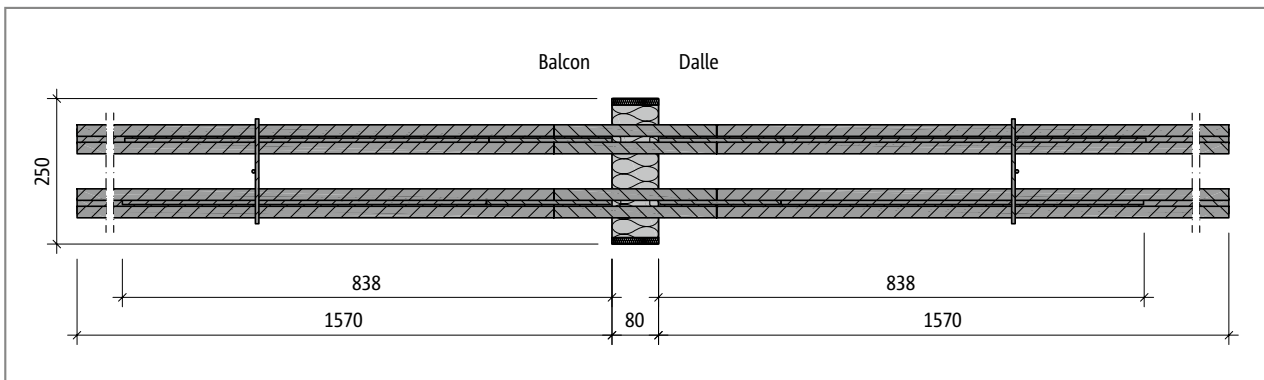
Schöck Isokorb® T Type B-M3-V2 : Plan de base du produit
